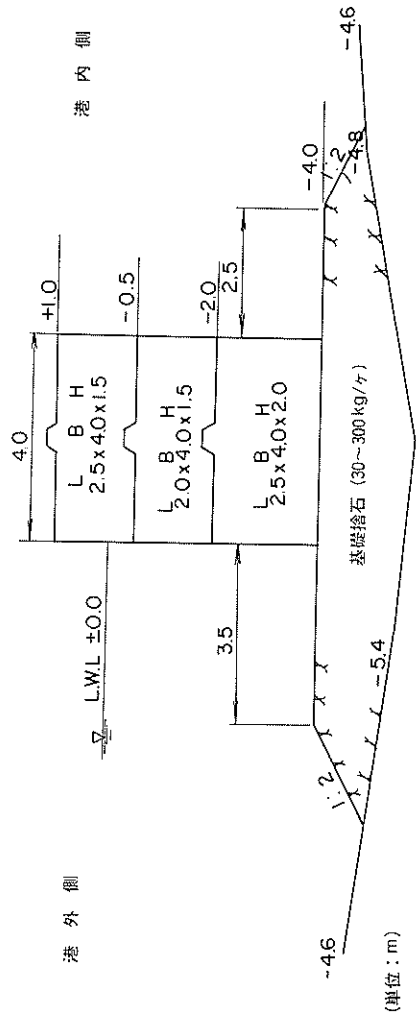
コンクリートブロック式混成堤の標準断面例(函館港)
